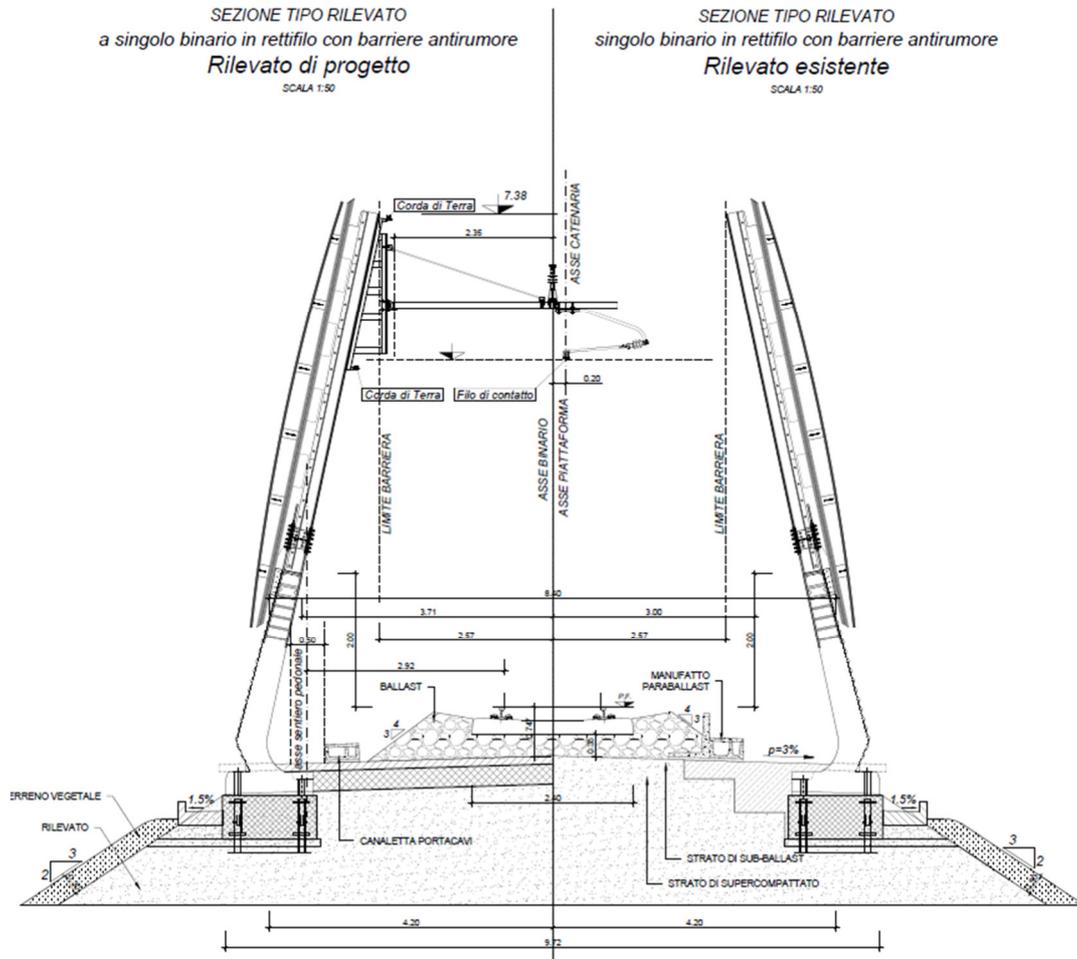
Sezione tipo in trincea a singolo binario con barriere antirumore e palo TE, installazione su nuovo rilevato e su rilevato esistente
